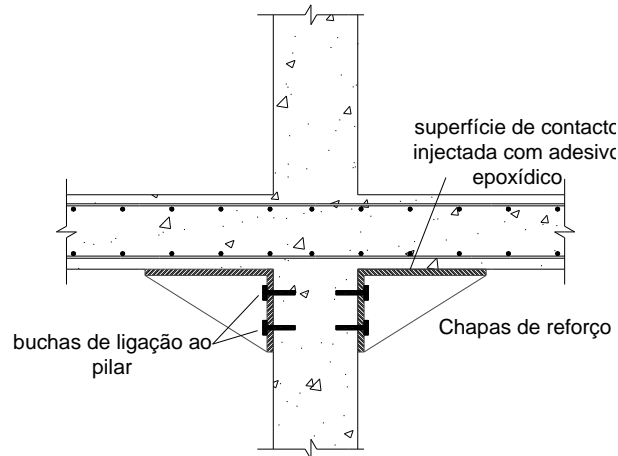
Reforço por adição de capitel metálico ou chapas metálicas.
